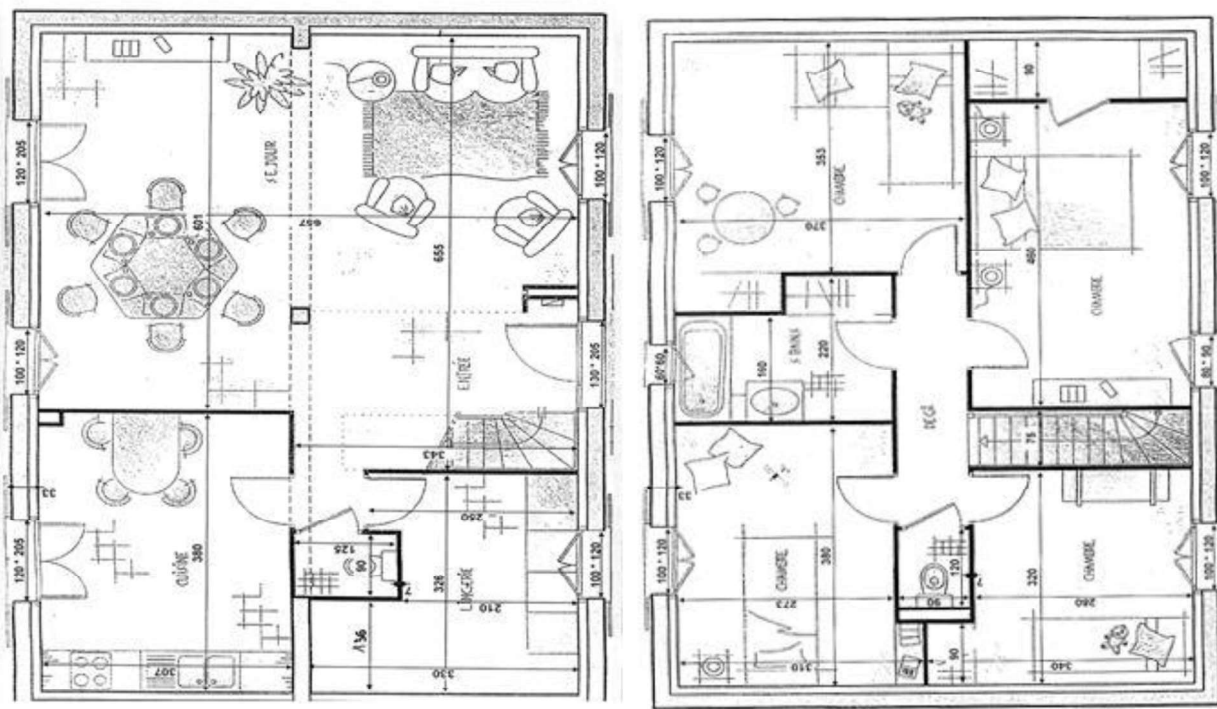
Plans du rez de chaussée et de l'étage de la maison type.
